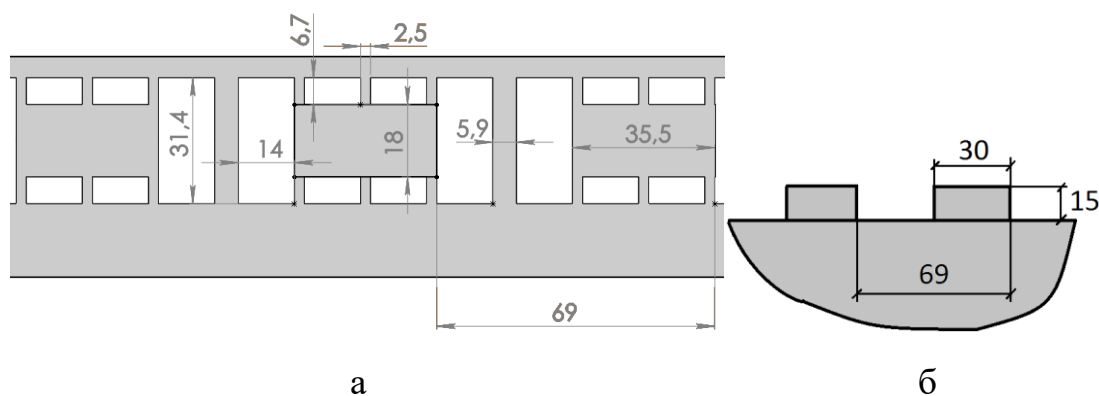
Схемы устройств гашения колебаний: а – прямоугольные щиты на передних перилах, б – прямоугольные пластины, закрепленные на нижней полке главной балки (вид на пролетное строение снизу)
